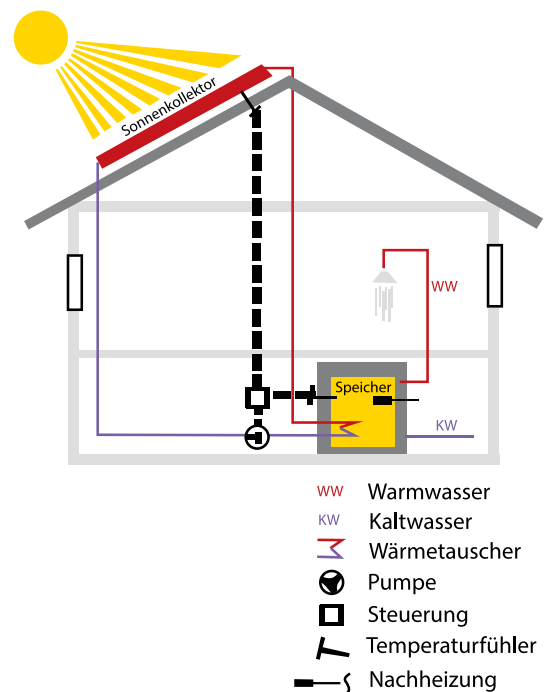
| Anlageschema: Solare Warmwasserbereitung
